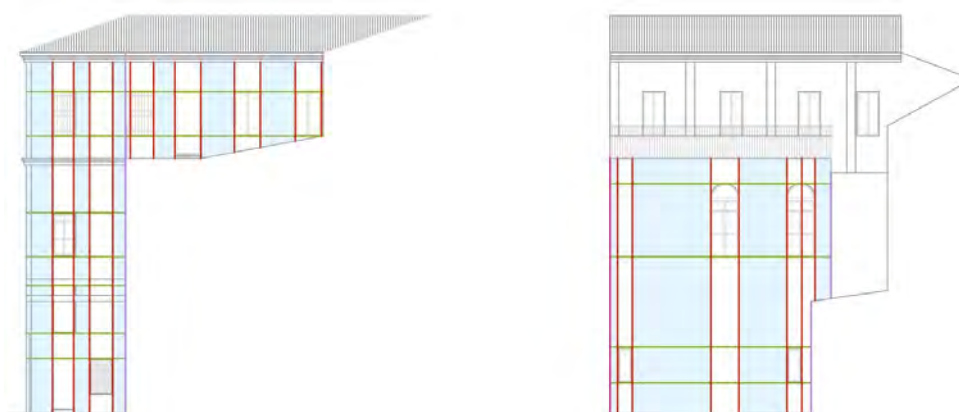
Prospetto Sud e Prospetto Ovest su cortile
